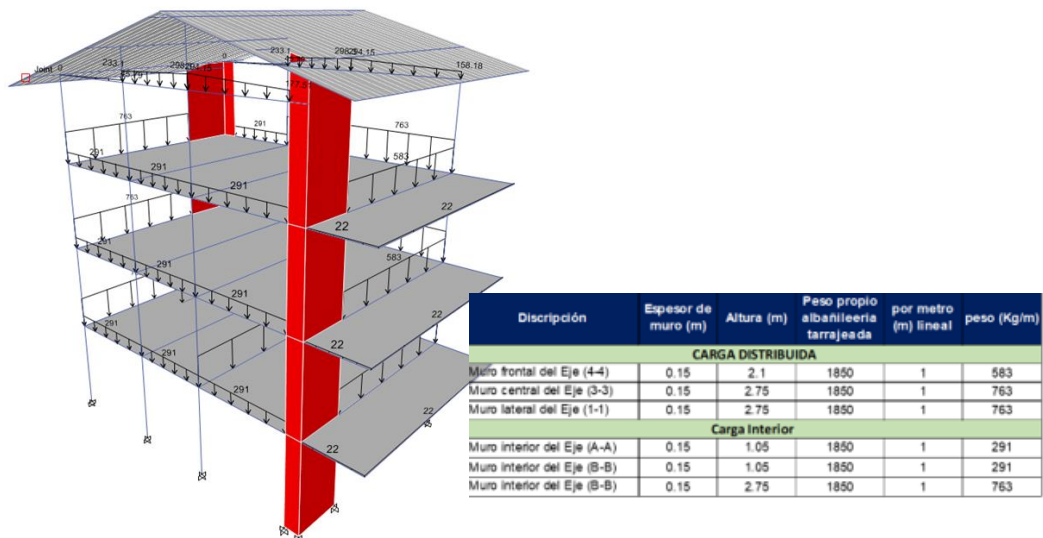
Cargas Distribuidas en Vigas en el Módulo N° 3
